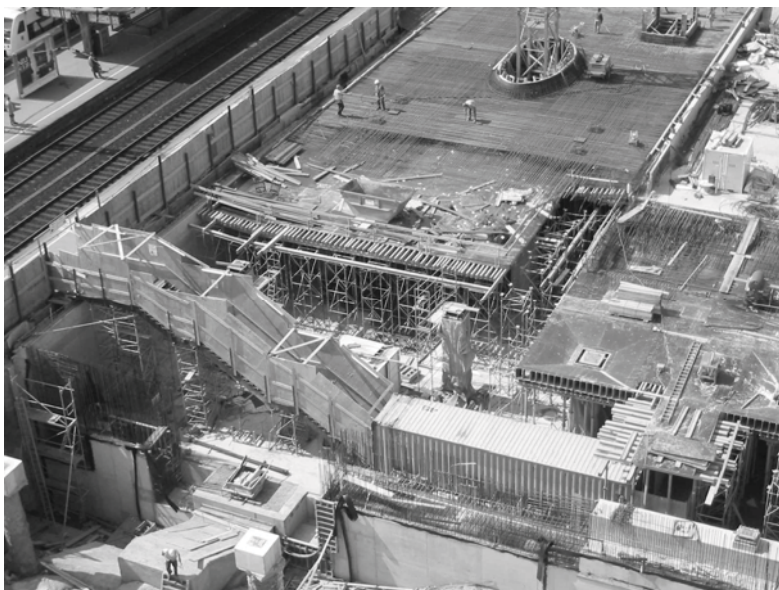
Das Bahnhofsgebäude (eigentlich Brückenbauwerk) wird erstellt
